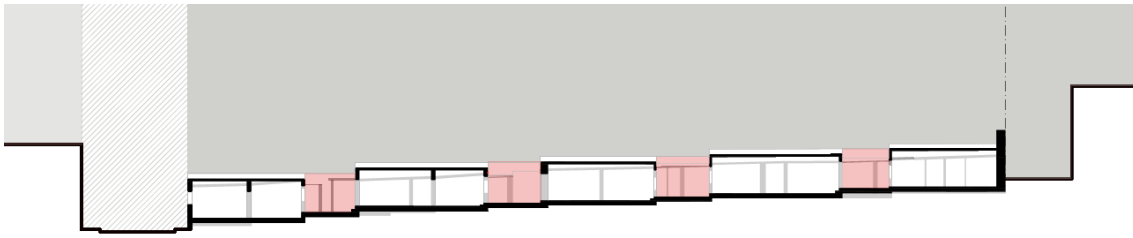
Esquema de ocupação em corte: relação do interior da ilha C com a envolvente (fonte: autores).
